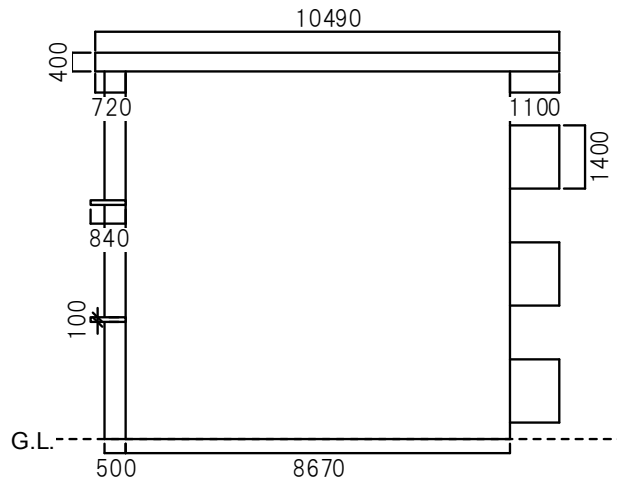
片岸市営住宅 西立面図 (単位: mm)
